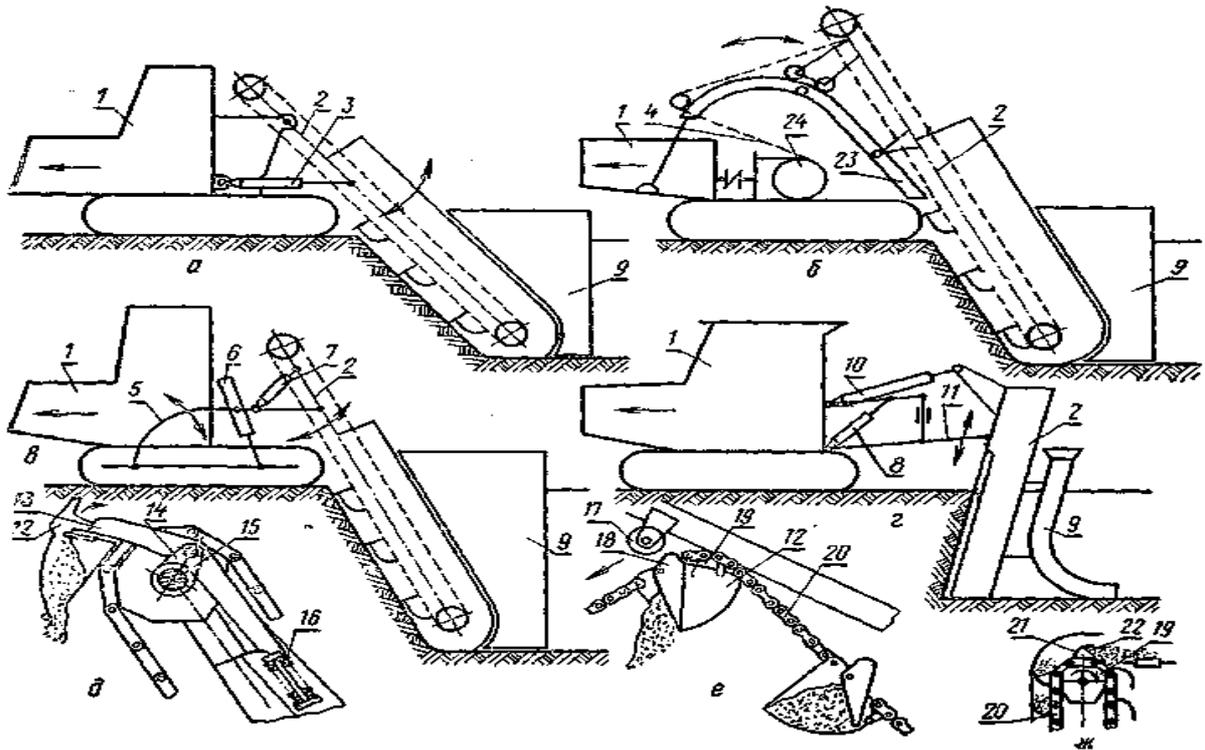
Схемы навески землеройного рабочего оборудования дренажных машин и очистителей ковшей:
